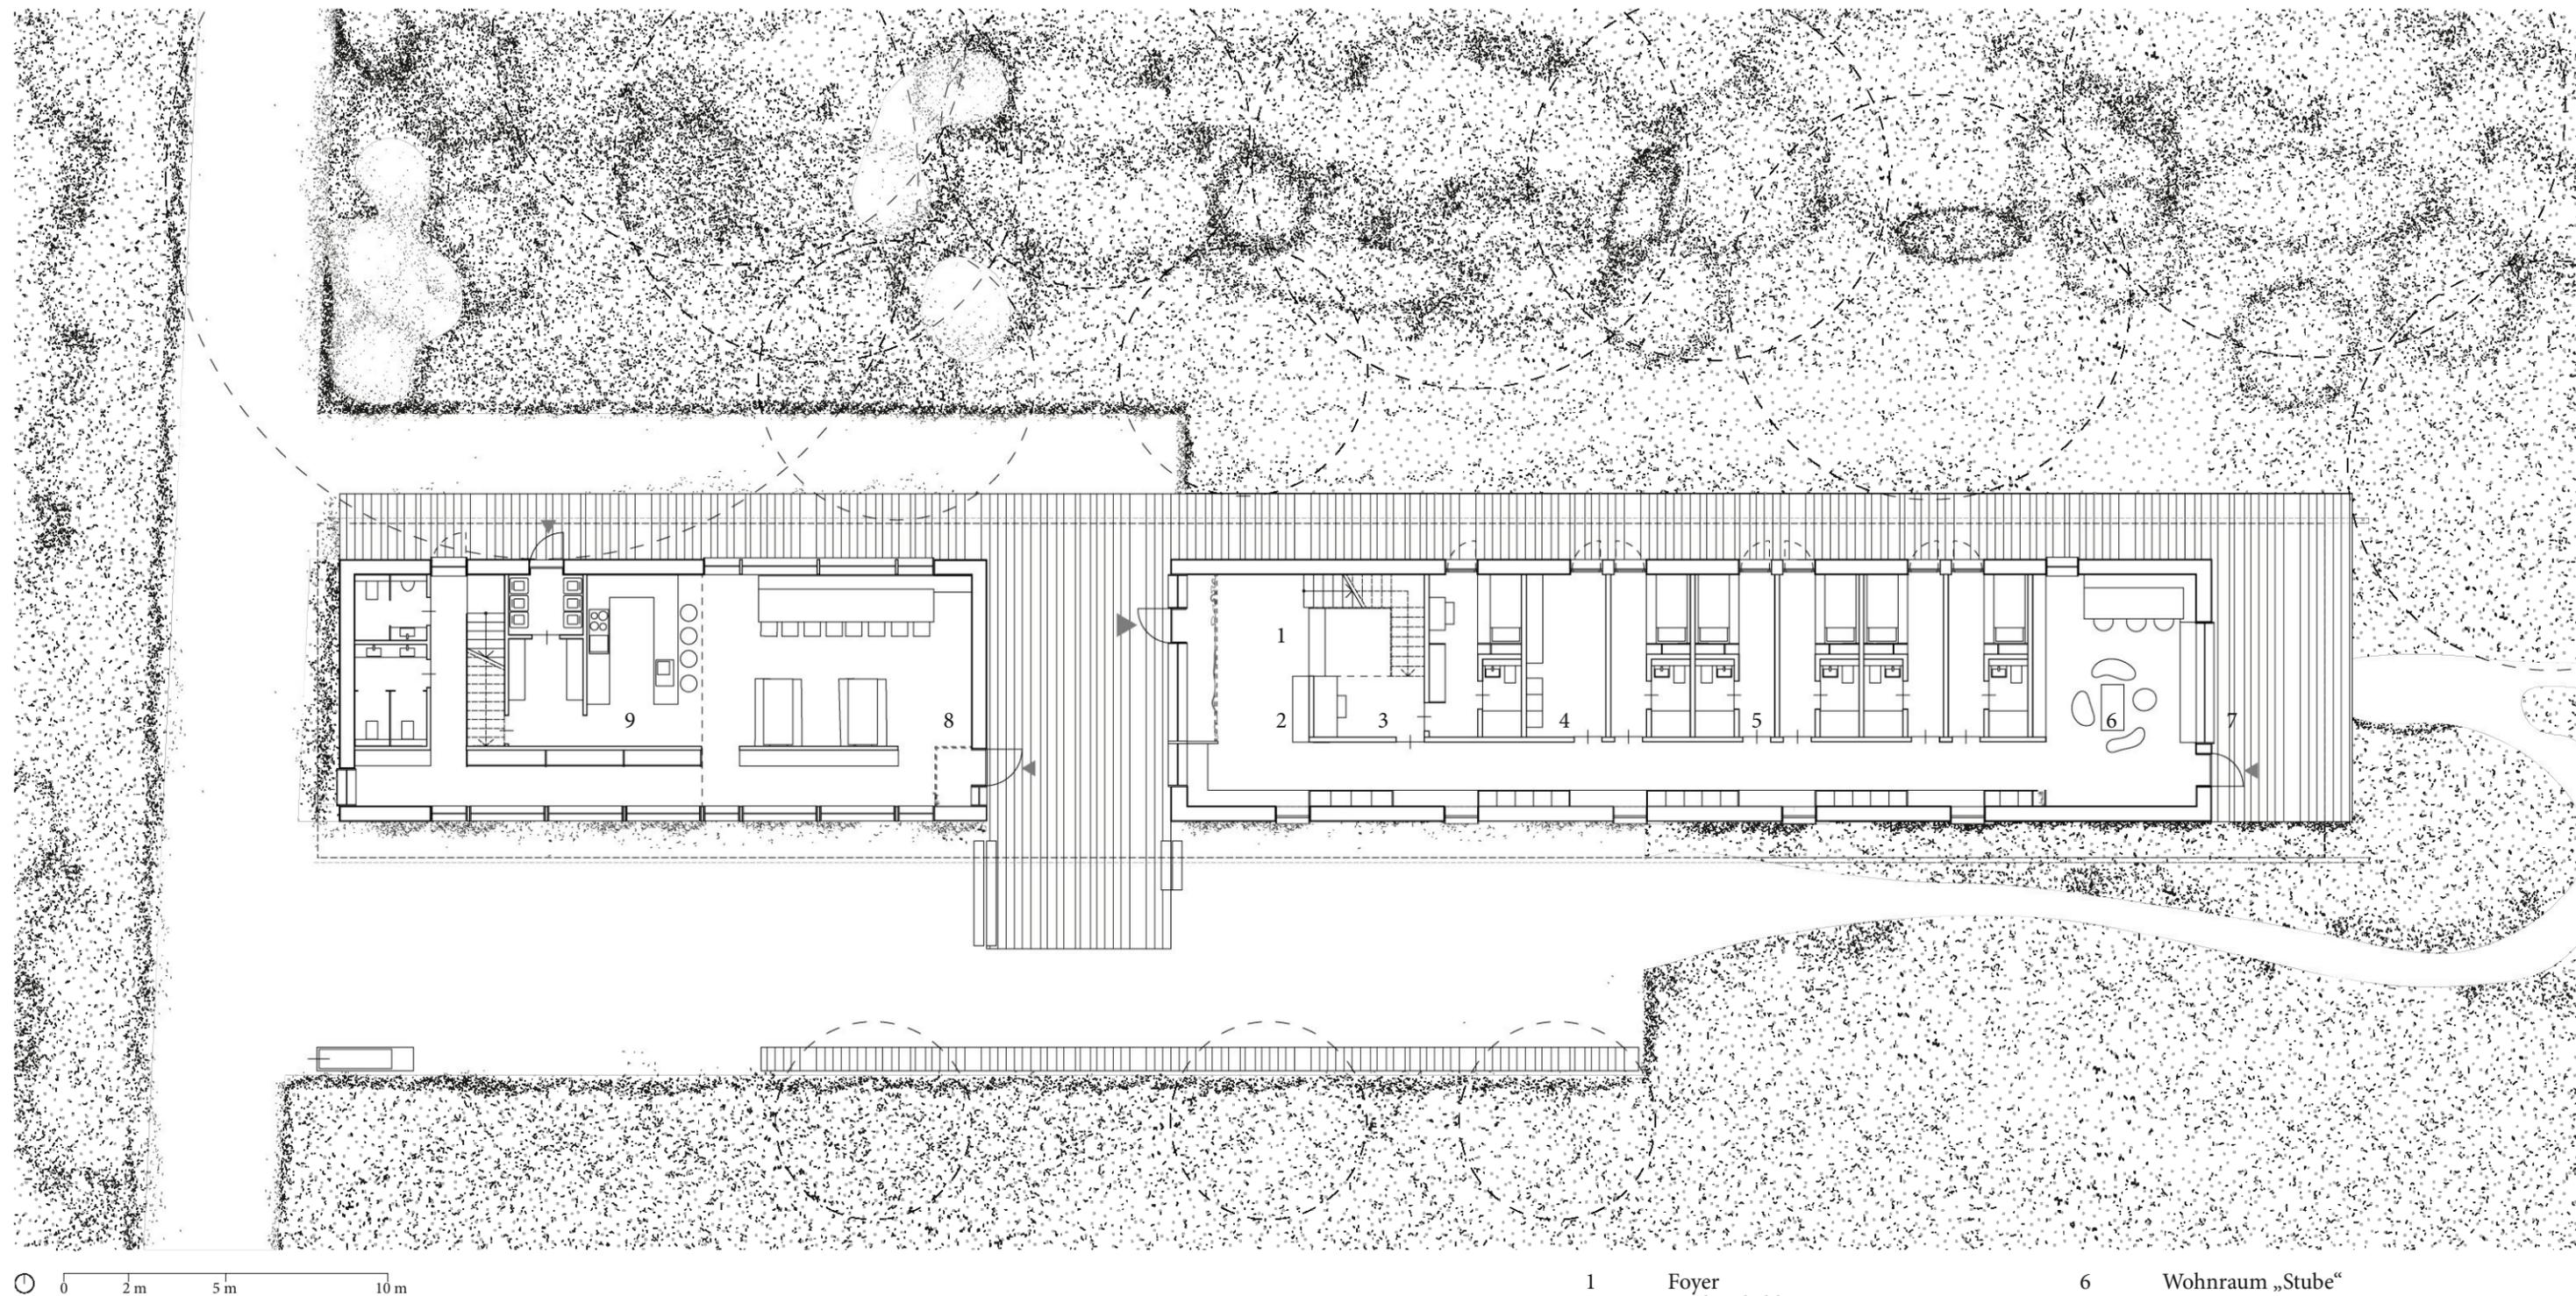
Grundriss Erdgeschoss M 1:200
